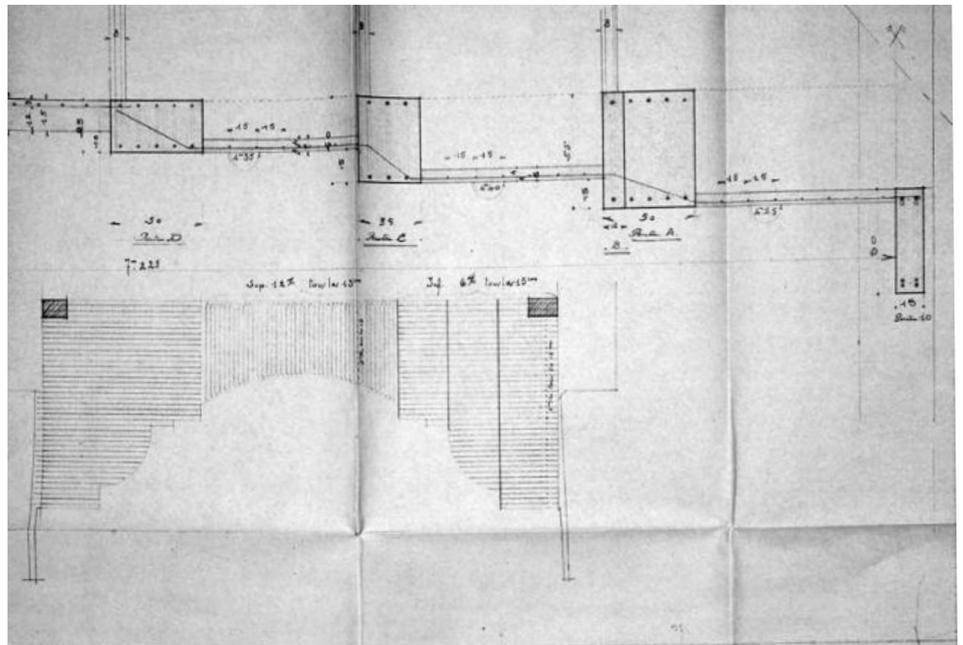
Plan d'armature du balcon avec l'implantation des poutrelles - Sources AD 22
